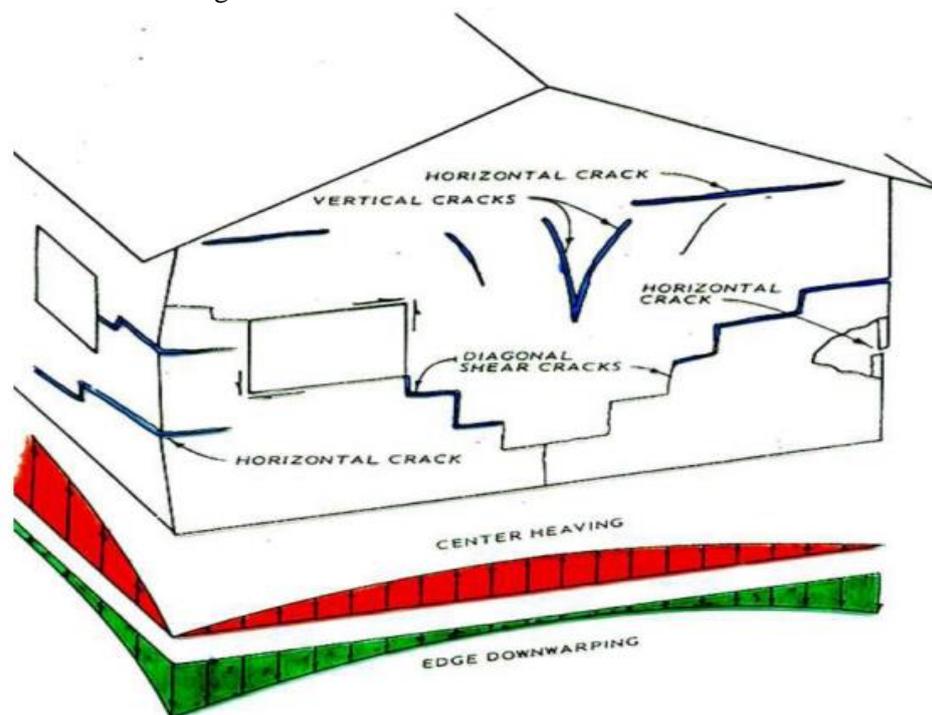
Manifestation des tassements (Fissuration).
